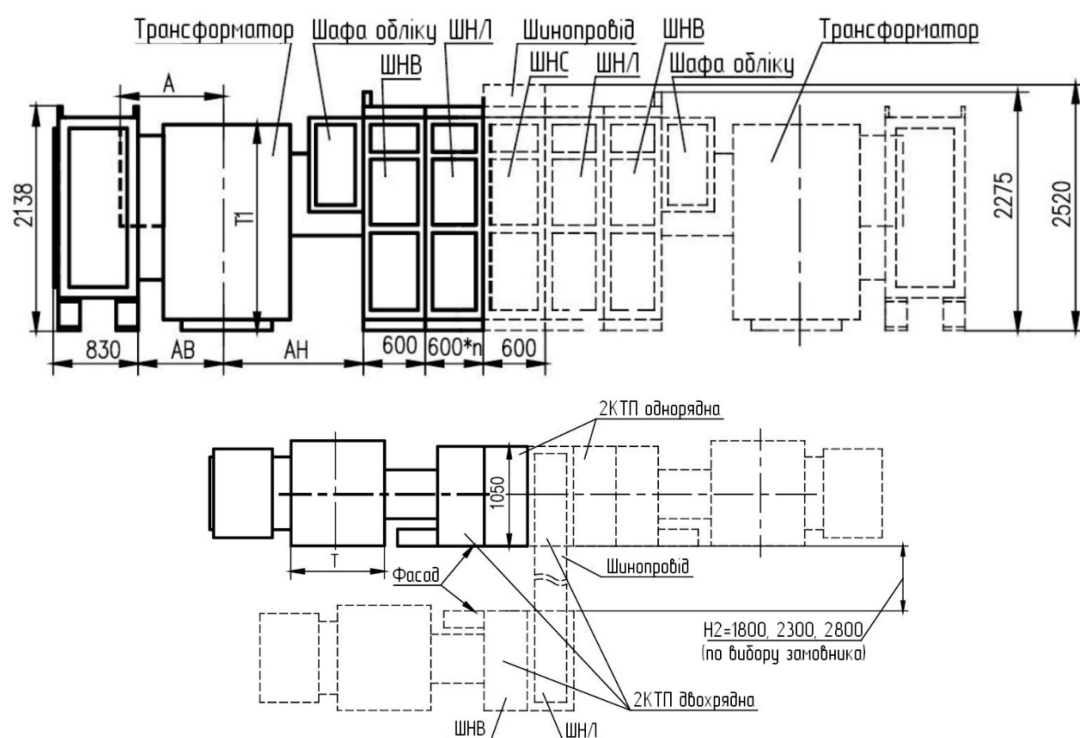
Габаритні розміри типової КТП-630 з РУНН збірної конструкції
